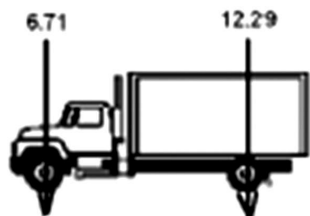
Camión tipo C2, con las cargas por eje en toneladas
